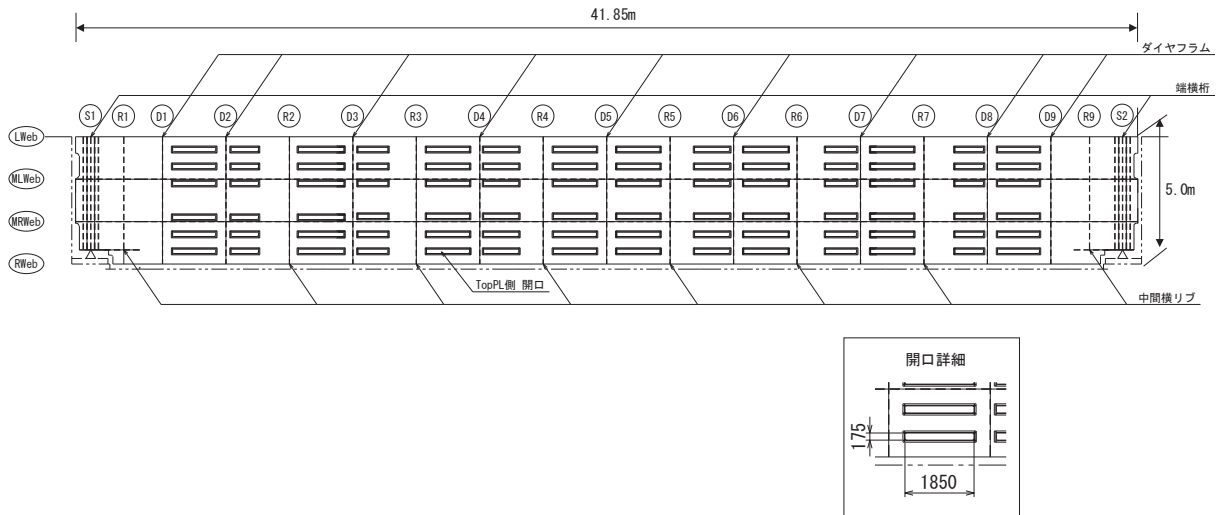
(2) 鋼製遮水壁 (鋼桁 1) 平面図
